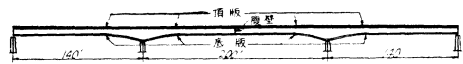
は連続桁部分の底版頂版および腹壁の施工継手の位置を示すものである。コンクリートは底版，腹壁および隔壁，頂版の順序で施工した。底版のコンクリート打設に先立つて，この部分の死荷重による理論的タワミに対応して型ワクにキャンバーをつけた。そのためには支保トラスの各格点に 6.5 in・10 t の水圧ジャッキを置き，底版を持ち上げて，クサビをかまし，かつ腹壁，隔壁および頂版のコンクリートの施工中においても底版を計画高に保つようにした。内側の型ワク取りはずしの便宜のために底版に一時的な孔を設けておき，型ワクを取りはずしたのちコンクリートを填充してふさいだ。
